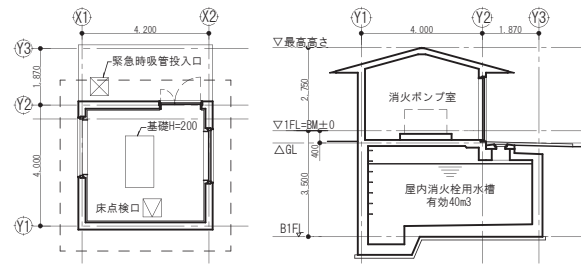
消火ポンプ室 平面図・断面図（竣工）
